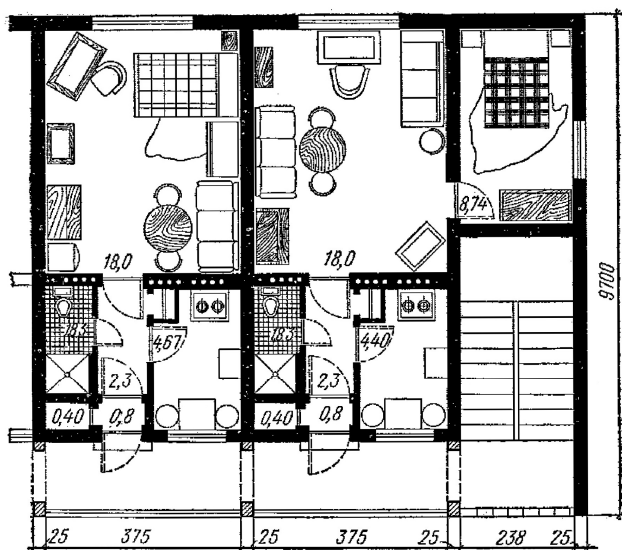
Фрагмент плана 4-этажного жилого дома галерейного типа
